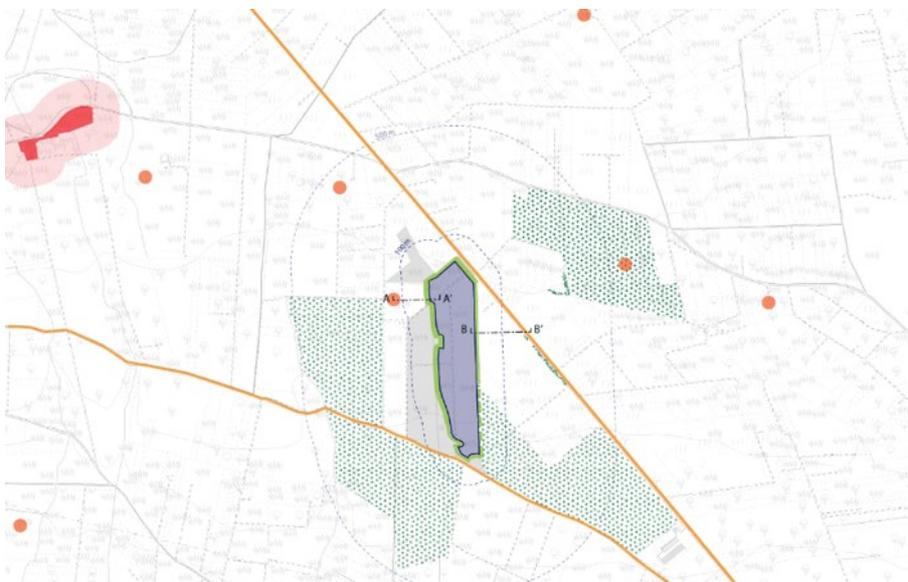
\_ Planimetria di individuazione delle fasce di mitigazione - Impianto di Cellino San Marco
